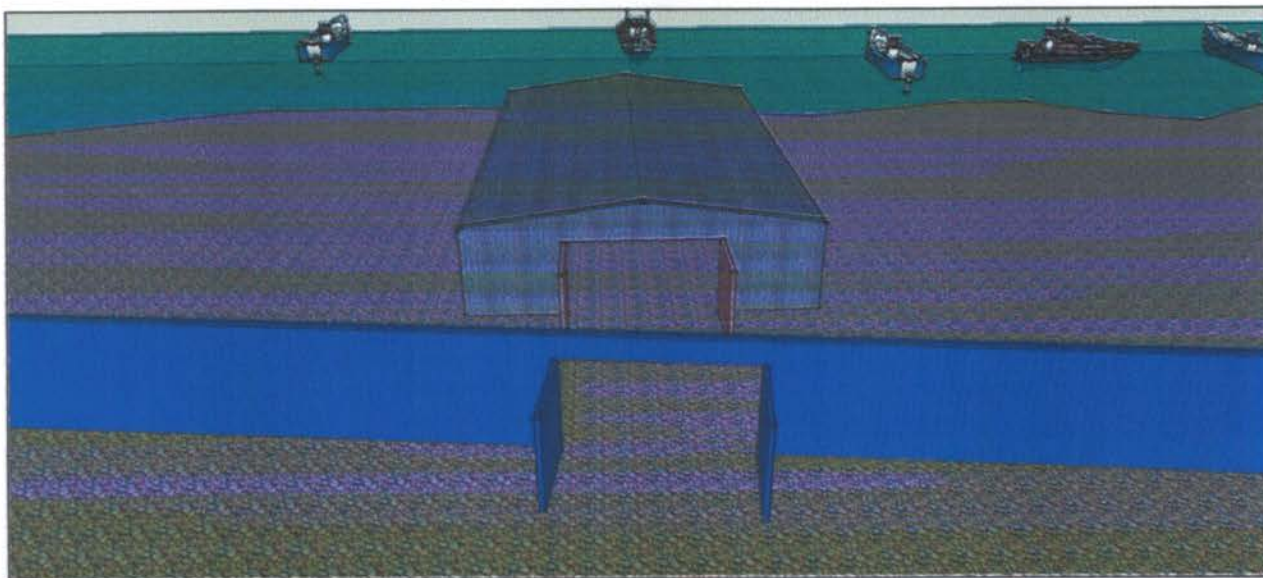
Esquema de galpón existente acondicionado acústicamente vista 2
